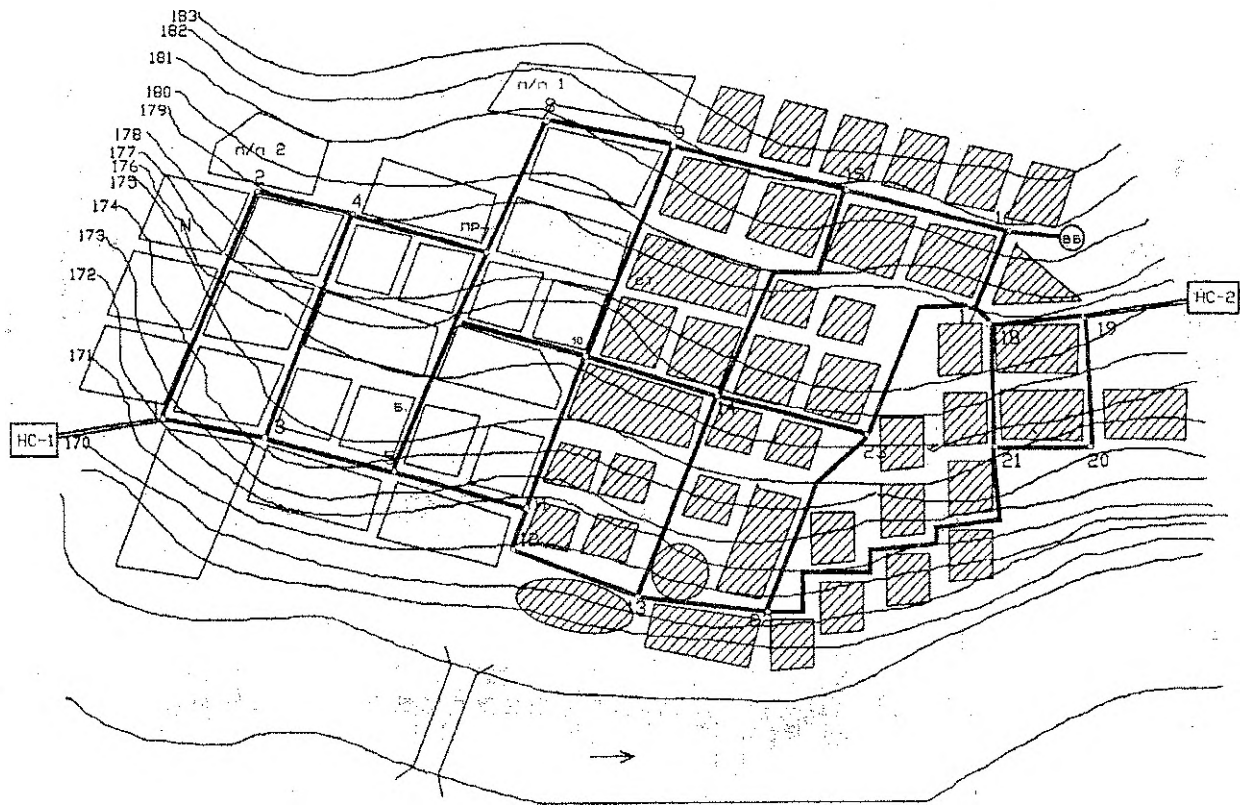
Трассировка водопроводной сети I очереди строительства
